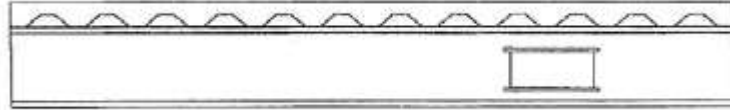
Vigas compuestas con losa de concreto sobre lámina acanalada
